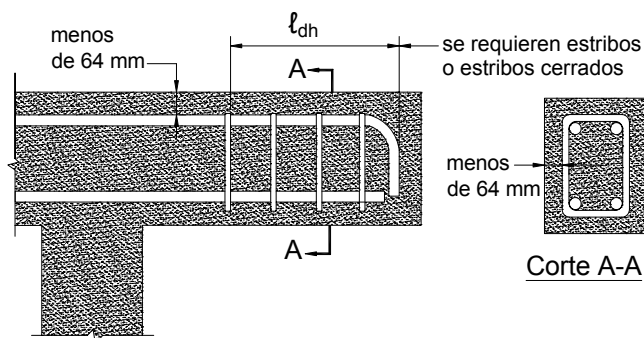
Estribos para las barras terminadas en gancho
